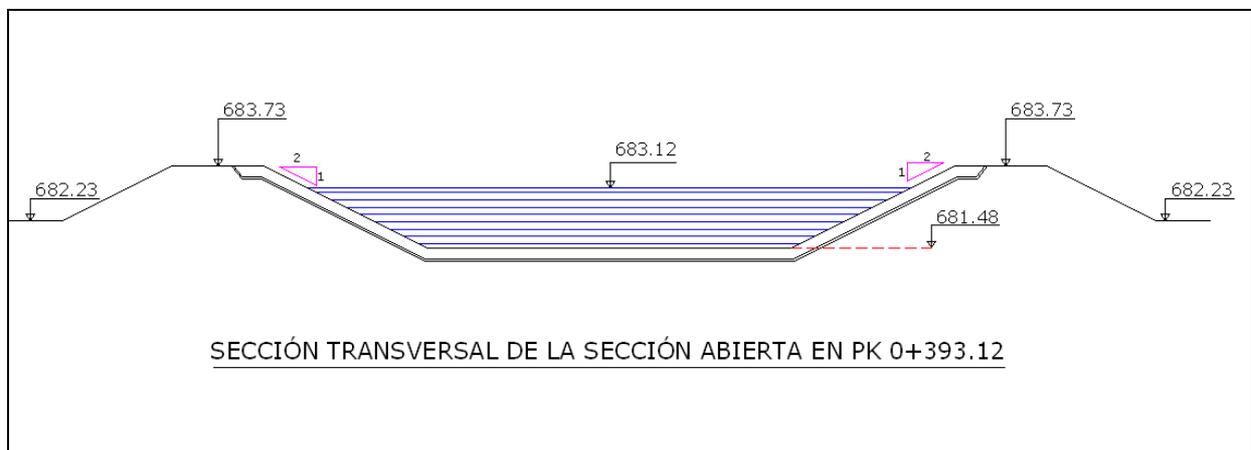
Sección transversal de la sección abierta del Marco Principal en PK 0+393.12
